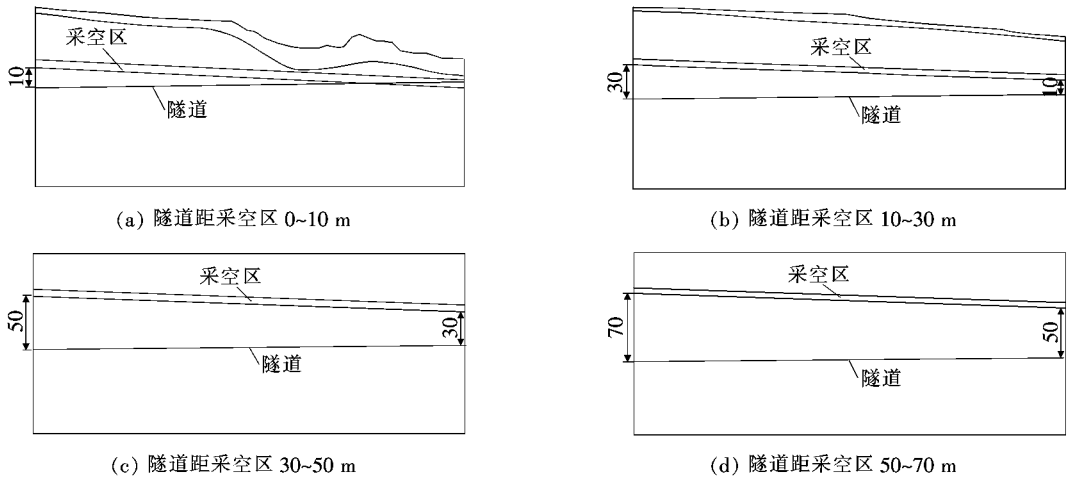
隧道与采空区相对位置纵断面示意图(单位:m)
